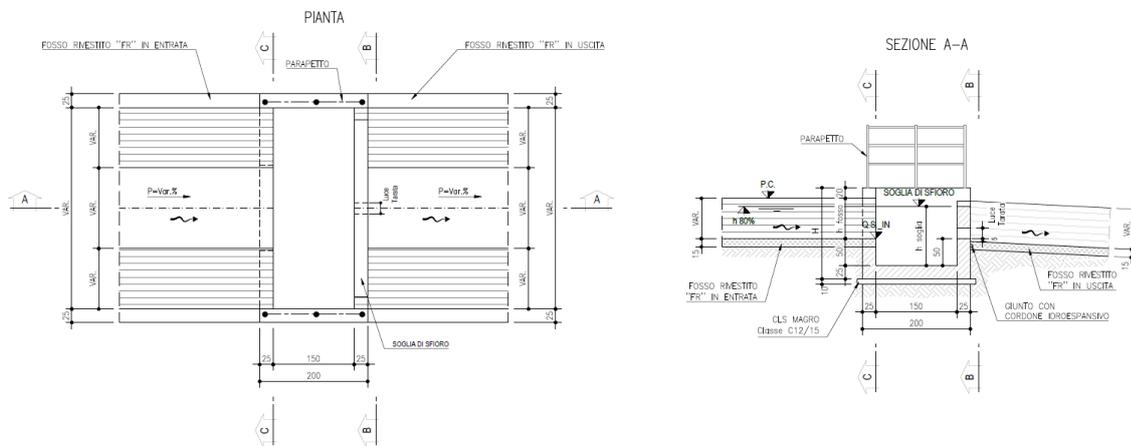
Sezione tipologica dei manufatti di regolazione tipo "MC1"
